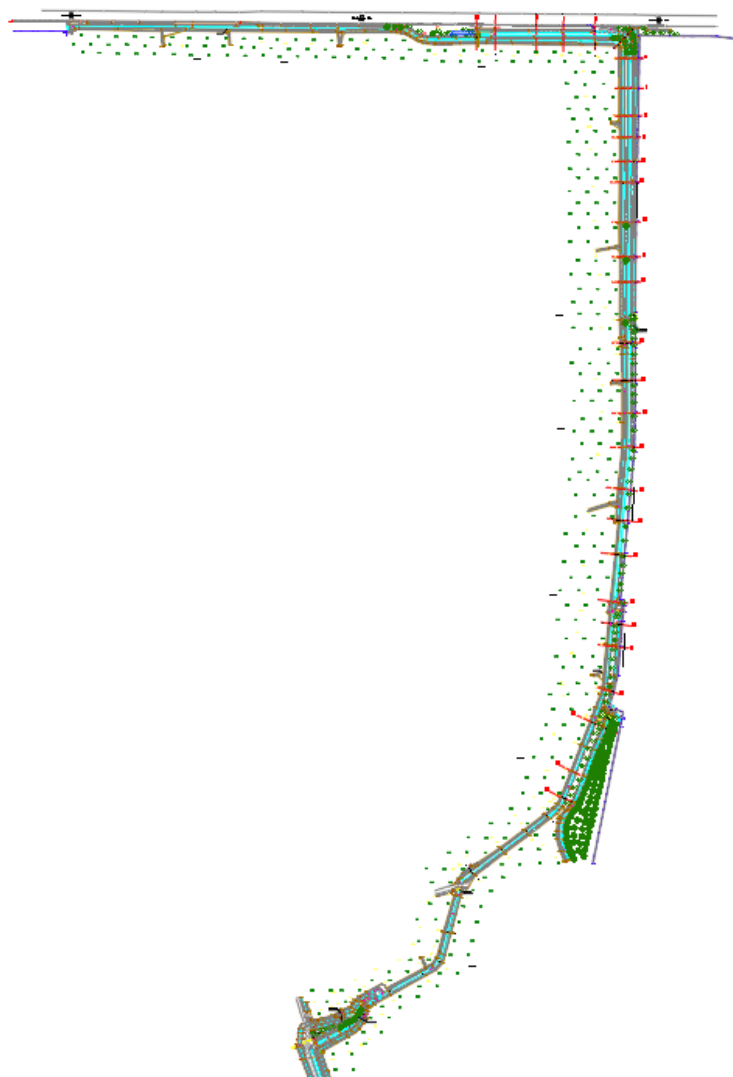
Rilievo topografico Cavo Cattedrale – Keyplan con ubicazione delle sezioni trasversali da modello
